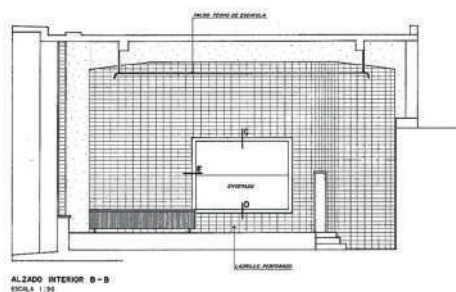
Alzado de la pared del estrado de las aulas de la Facultad de Derecho
